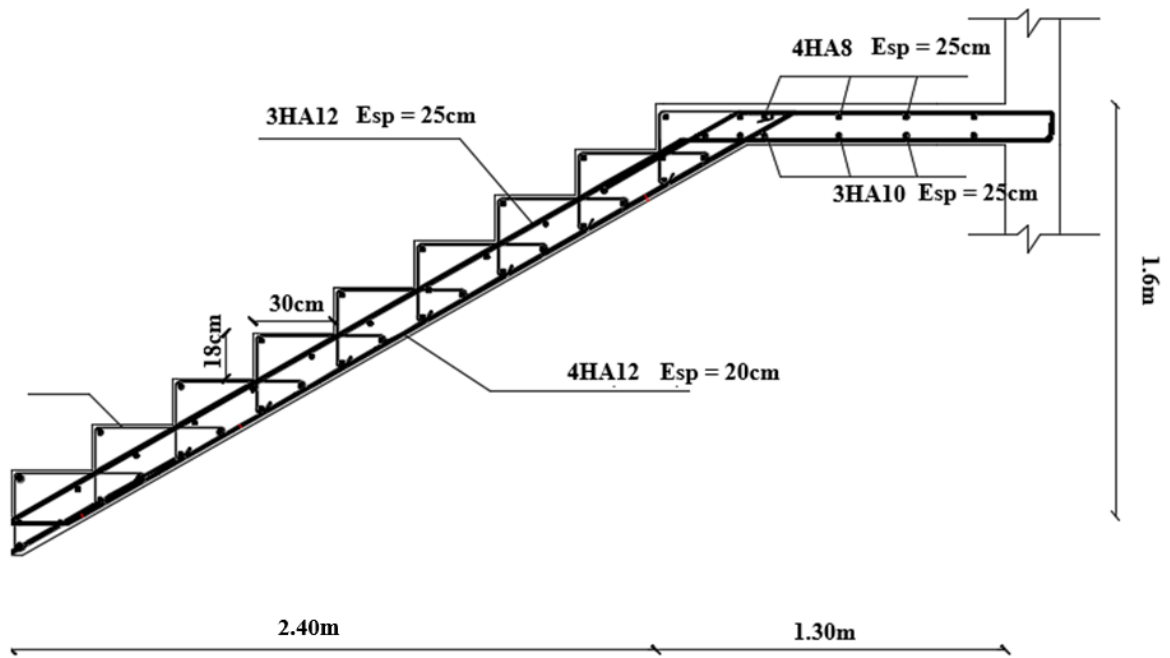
Schéma du ferrailage de la volée de l'escalier
